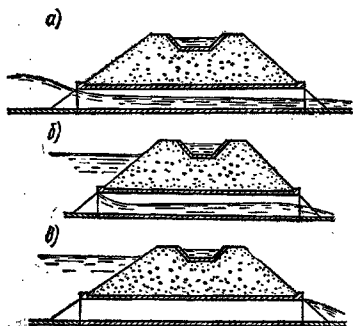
Схемы гидравлических режимов в трубах а — безнапорного; б — полунапорного; в — напорного
